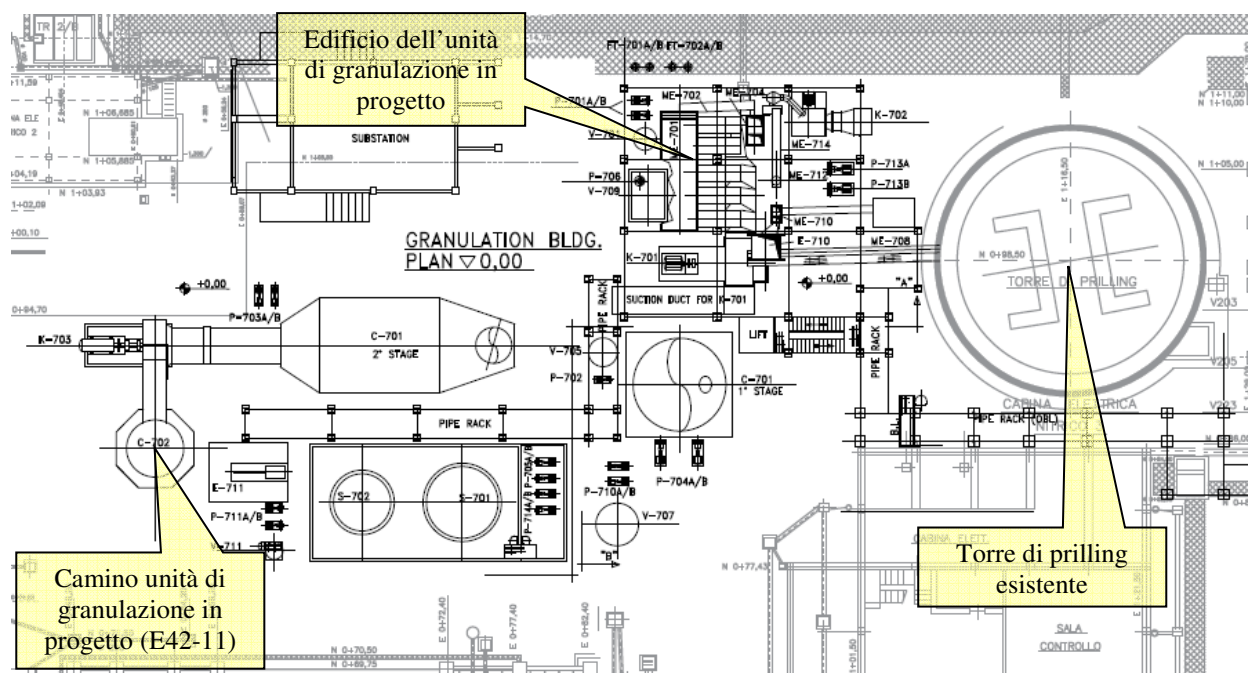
Planimetria dell'impianto in progetto (unità di granulazione) e nuovo punto emissivo E42-11
